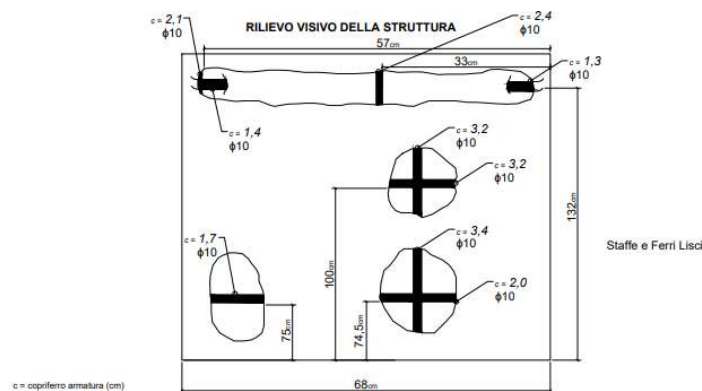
Esempio restituzione saggi e/o pacometrie/georadar su pile/pulvini e spalle
